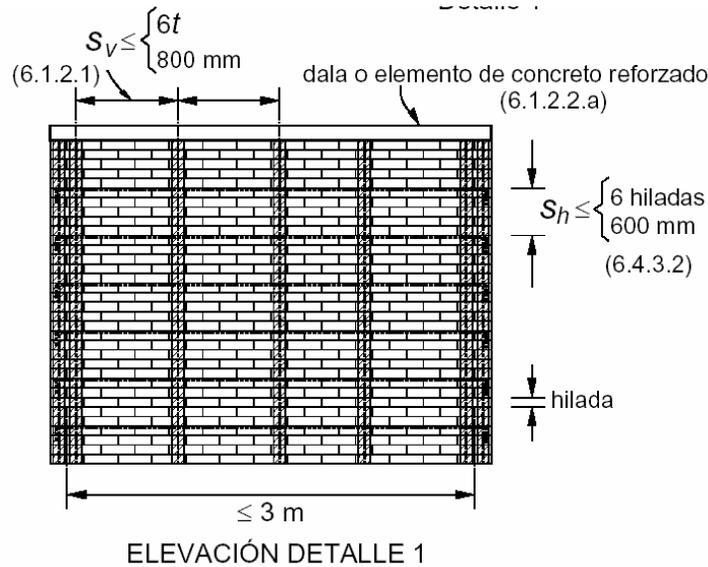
Figura R (Requisitos para Mampostería con Refuerzo Interior; Referencia 26)
